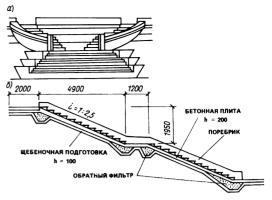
Открытая лестница: a — фасад; 6 — разрез
